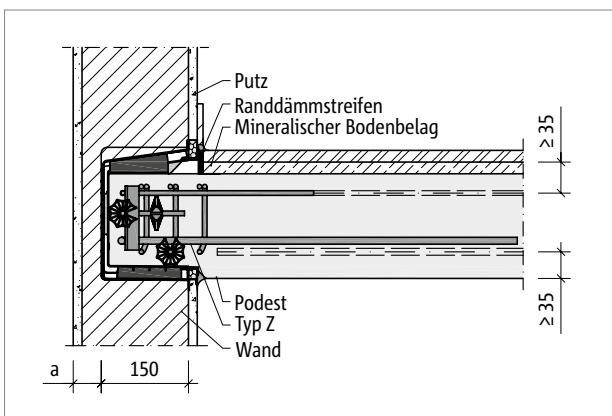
Schöck Tronsole® Typ Z: Brandschutzausführung
